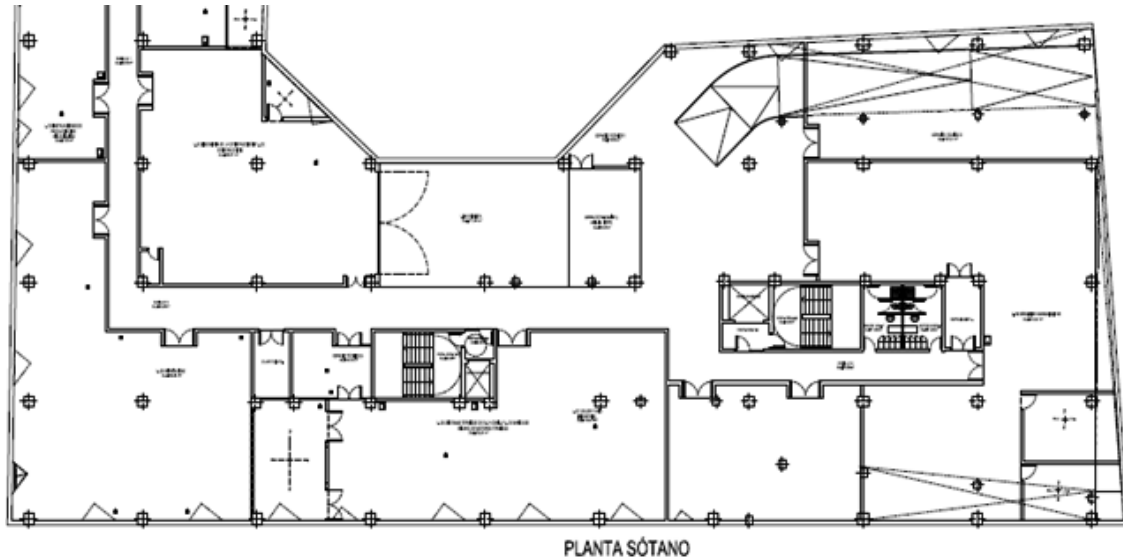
Laboratorio de hormigón (planta sótano)
